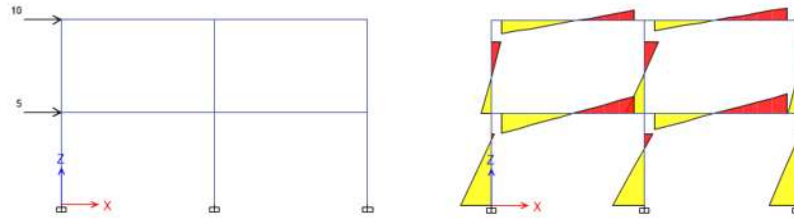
Elementos mecánicos máximos en vigas y columnas
